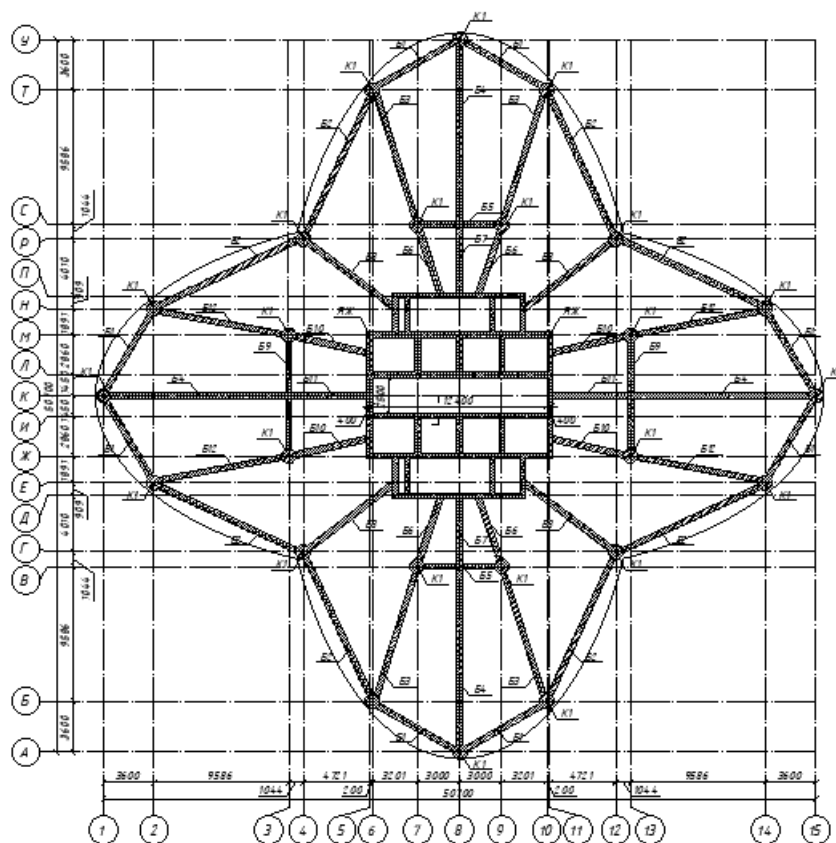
Схема расположения несущих элементов железобетонного каркаса
